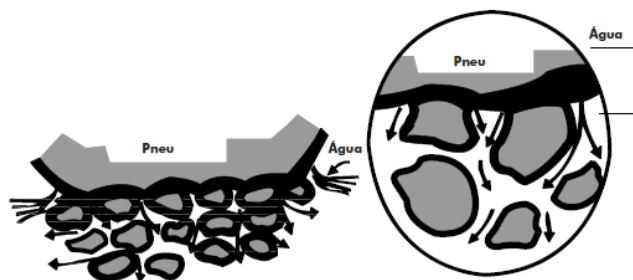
Contacto do pneu-pavimento numa mistura betuminosa drenante (Fonte: PAVIDREN)
